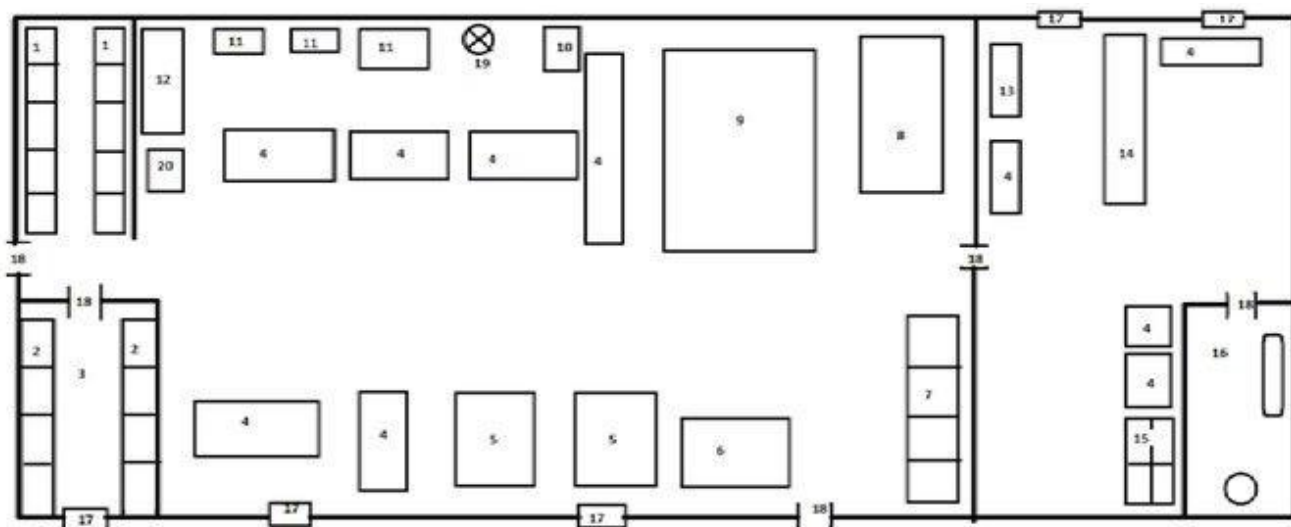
Размещение оборудования в столовой: 1 – полка; 2 – шкафы для одежды; 3 – раздевалка; 4 – производственный стол; 5 – стеллажи для выпечки; 6 – упаковочная машина; 7 – полки для выпечки; 8 – хлебопекарная печь; 9 – жарочный шкаф; 10 – умывальник; 11 – тестомесильная машина; 12 – тестораскаточная машина; 13 – моечная ванна; 14 – холодильный шкаф; 15 – плита электрическая; 16 – туалет; 17 – окно; 18 – дверь; 19 – электрощит; 20 – мукопросеивательная машина
